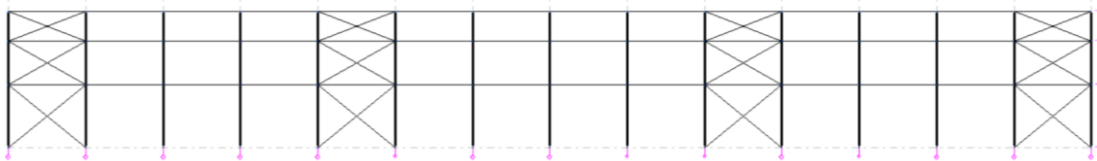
Una de las dos fachadas laterales exteriores. Fuente: CYPE
